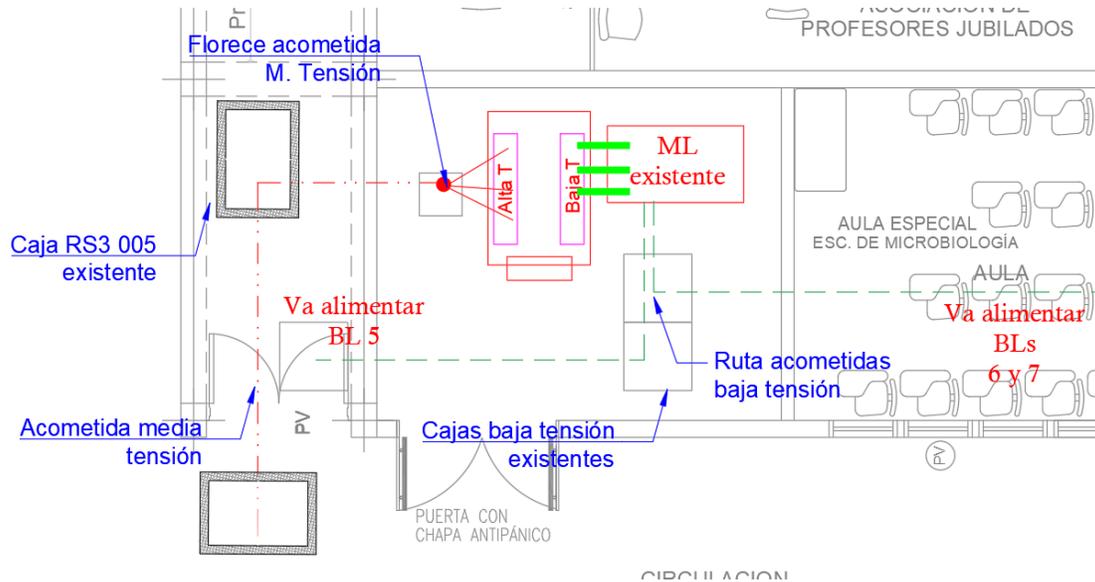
Estado actual subestación bloque 5 vista en planta.
